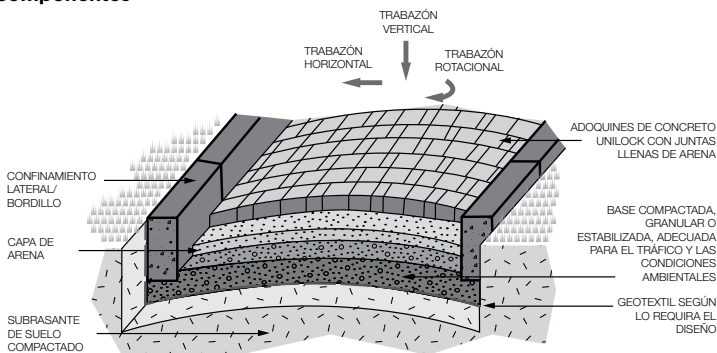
Componentes típicos de un sistema de pavimento de adoquines de concreto
